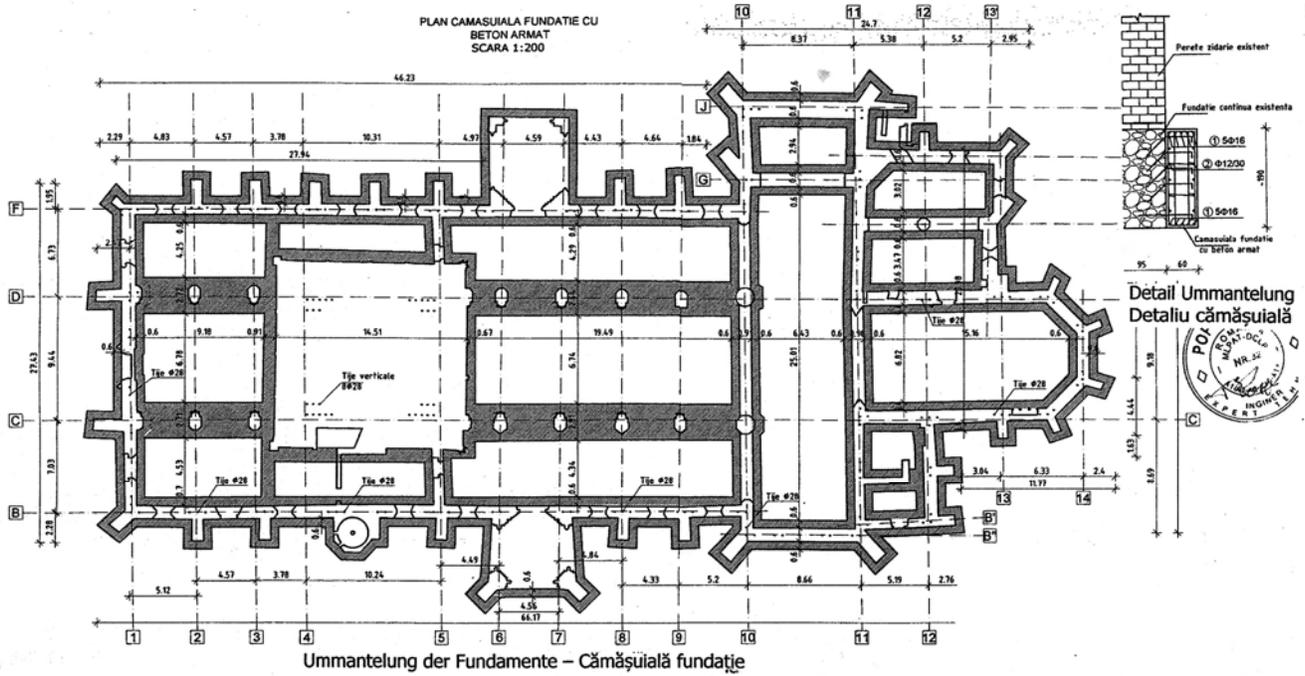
Grundriss Fundament. Zeichnung aus dem Projekt Popp & Asociați.
